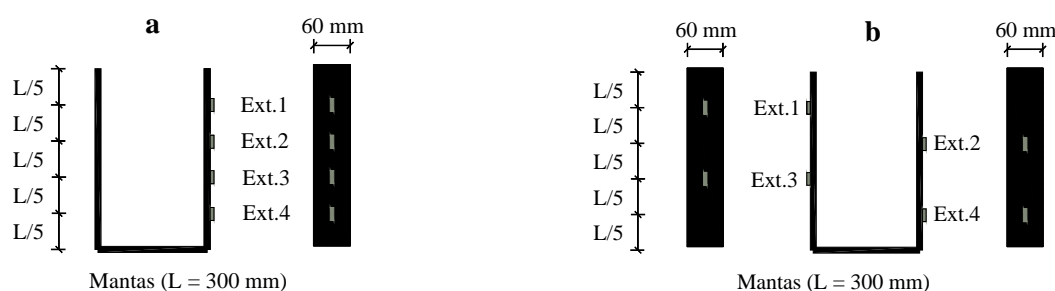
Disposição dos extensómetros aplicados na manta de CFRP instrumentada: a) vigas com $\rho_{sw} = 0.10\%$ e b) vigas com $\rho_{sw} = 0.17\%$.
